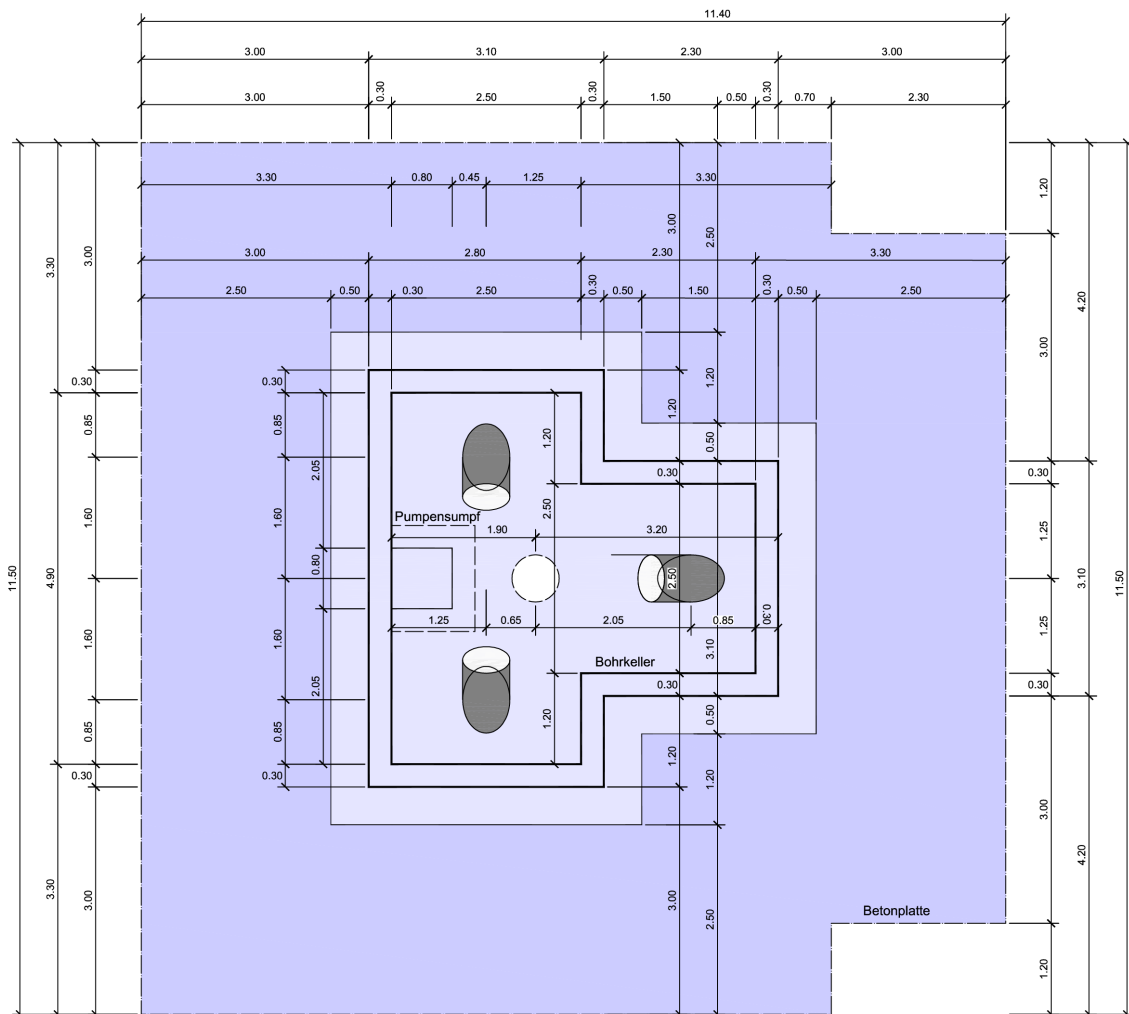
Grundriss des Bohrkellers für vier Bohrrichtungen.
